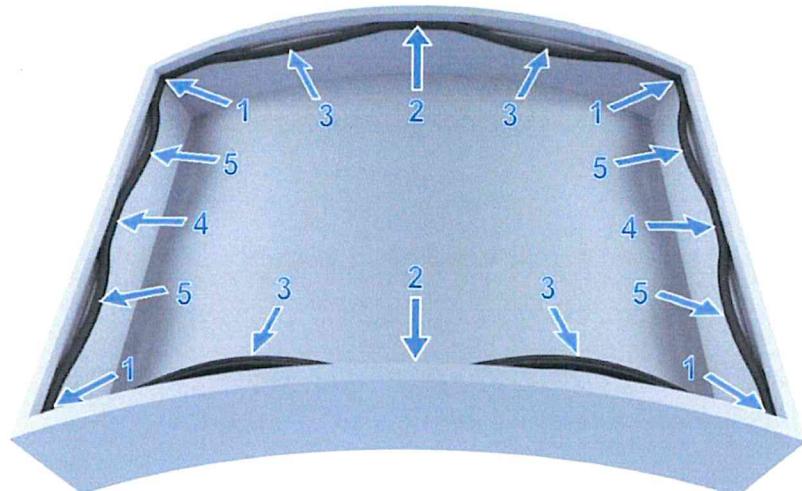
Séquence pour clipser le joint sur les moules de voussoirs
